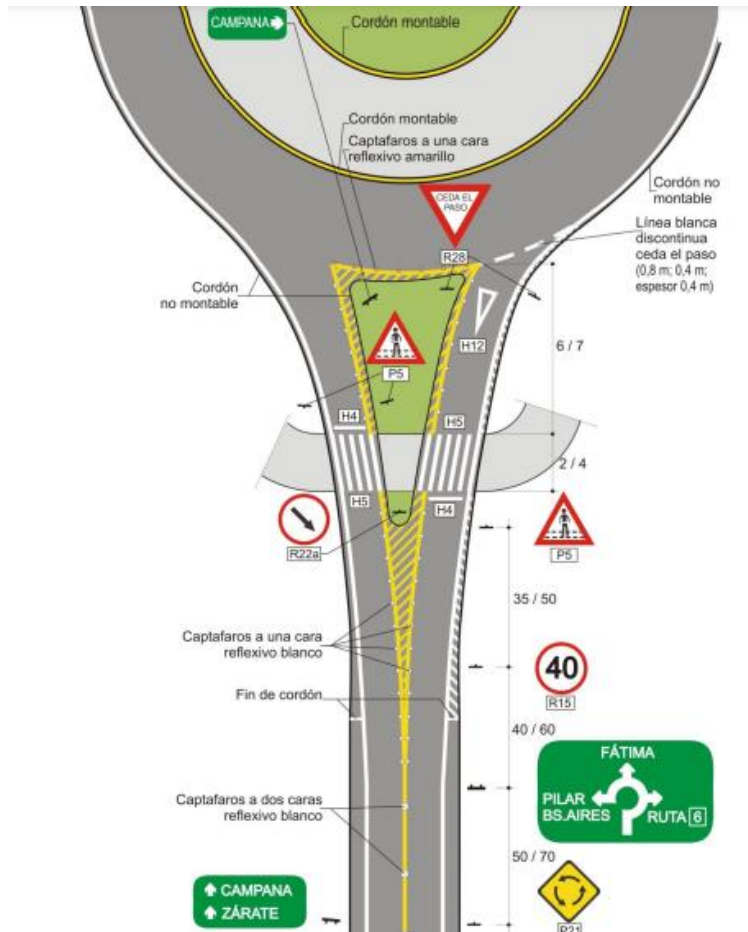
Representación de diámetro de 60 m en planta de espacio vial
